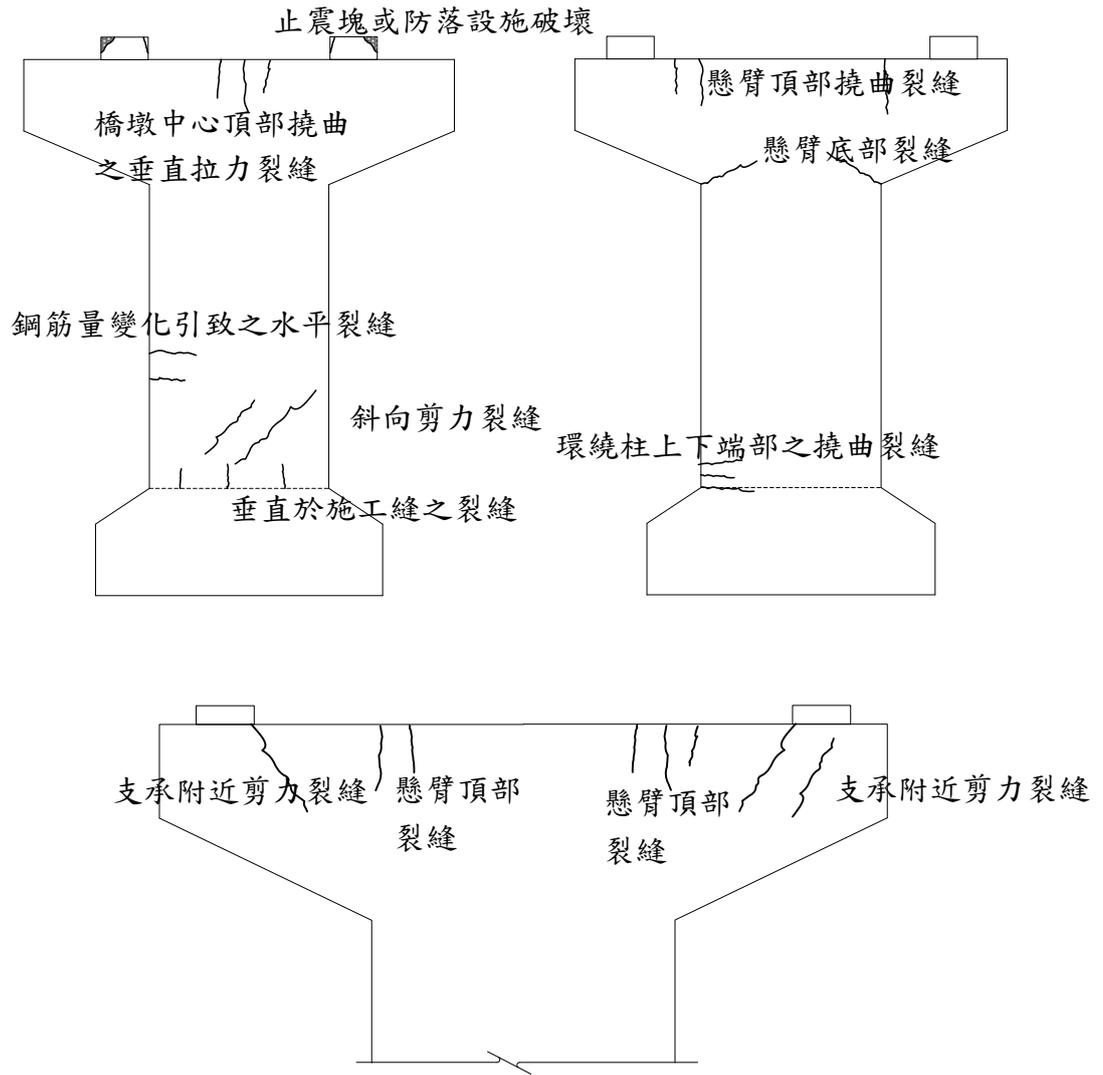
混凝土懸臂式單柱橋墩裂縫示意圖
